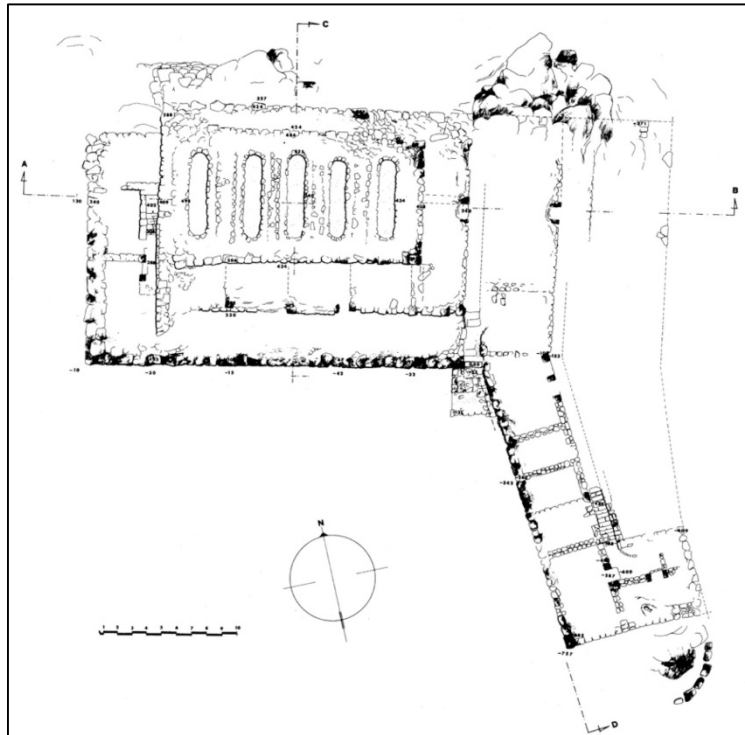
Planimetría del fortín de Ras ed-Drek donde se puede observar el muro perimetral del tipo M.0, así como las cinco cisterna “a bagnarola” (Barreca, 1983a).
